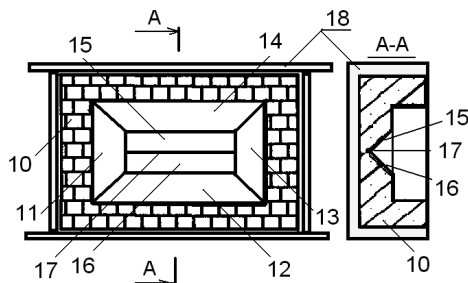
Схема предохранительной разрушающейся конструкции ограждения зданий
